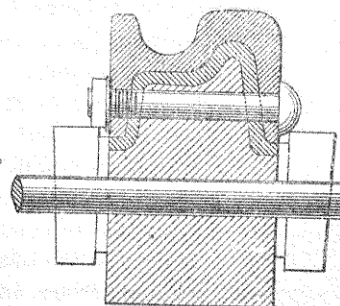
Coupe montrant l'éclisse et l'about d'une entretoise. Échelle 1/4.
